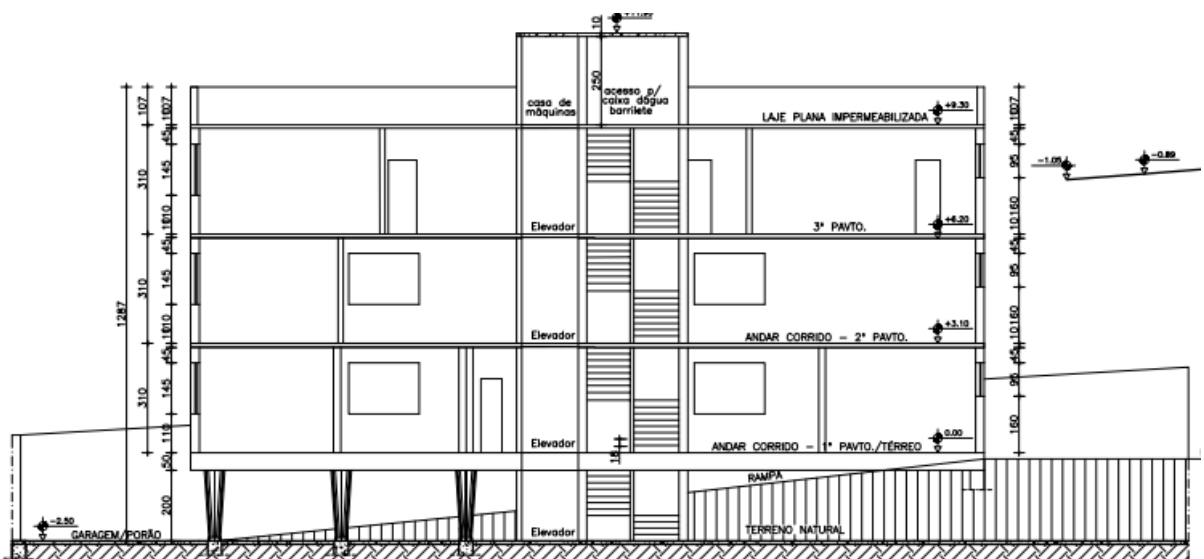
Aprovação inicial, em 1960, com área de 1.396 m<sup>2</sup>, edificação com 03 pavimentos. Fonte: edificações.pbh - Portal de edificações de Belo Horizonte.
